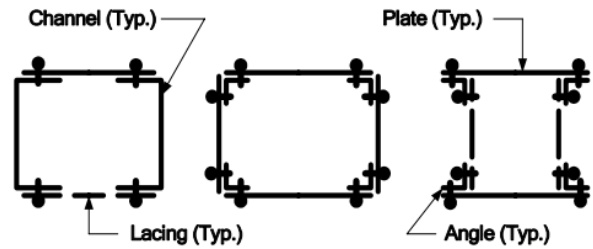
Perfiles Armados en Caja - Internamente Redundante.[6]
